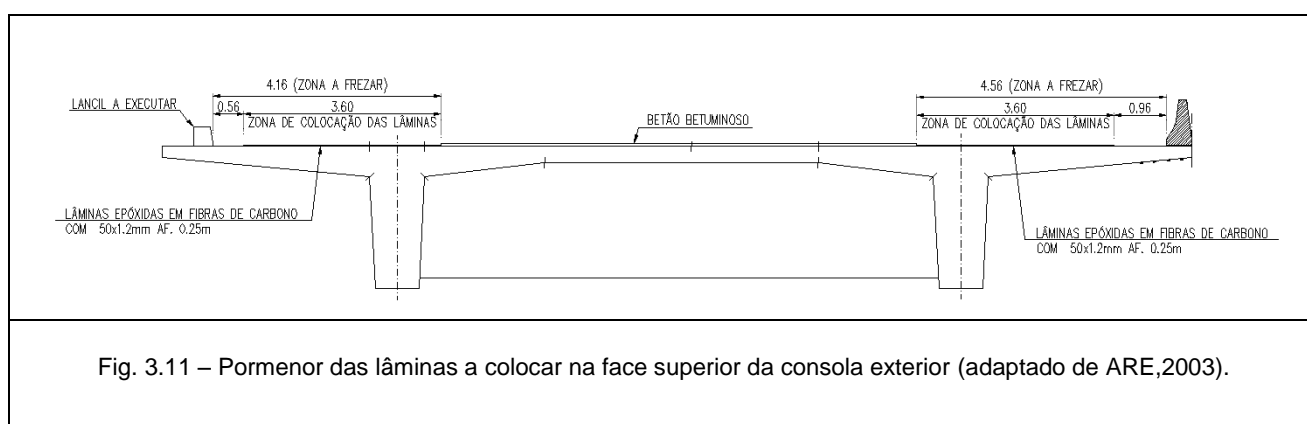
Pormenor das lâminas a colocar na face superior da consola exterior (adaptado de ARE,2003).
